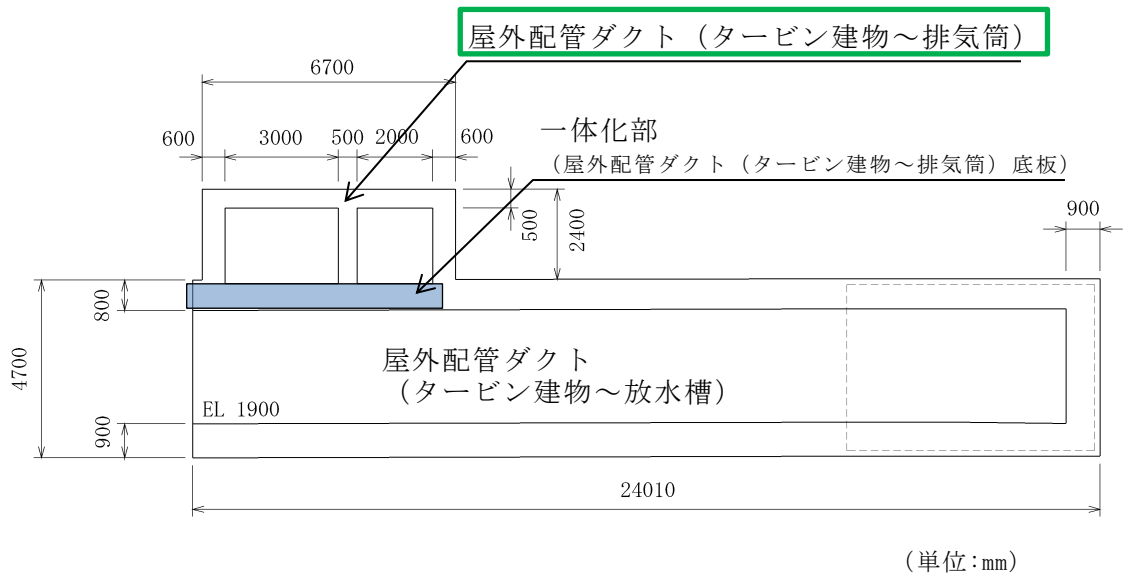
屋外配管ダクト (タービン建物～排気筒) 断面図 (B-B 断面)
